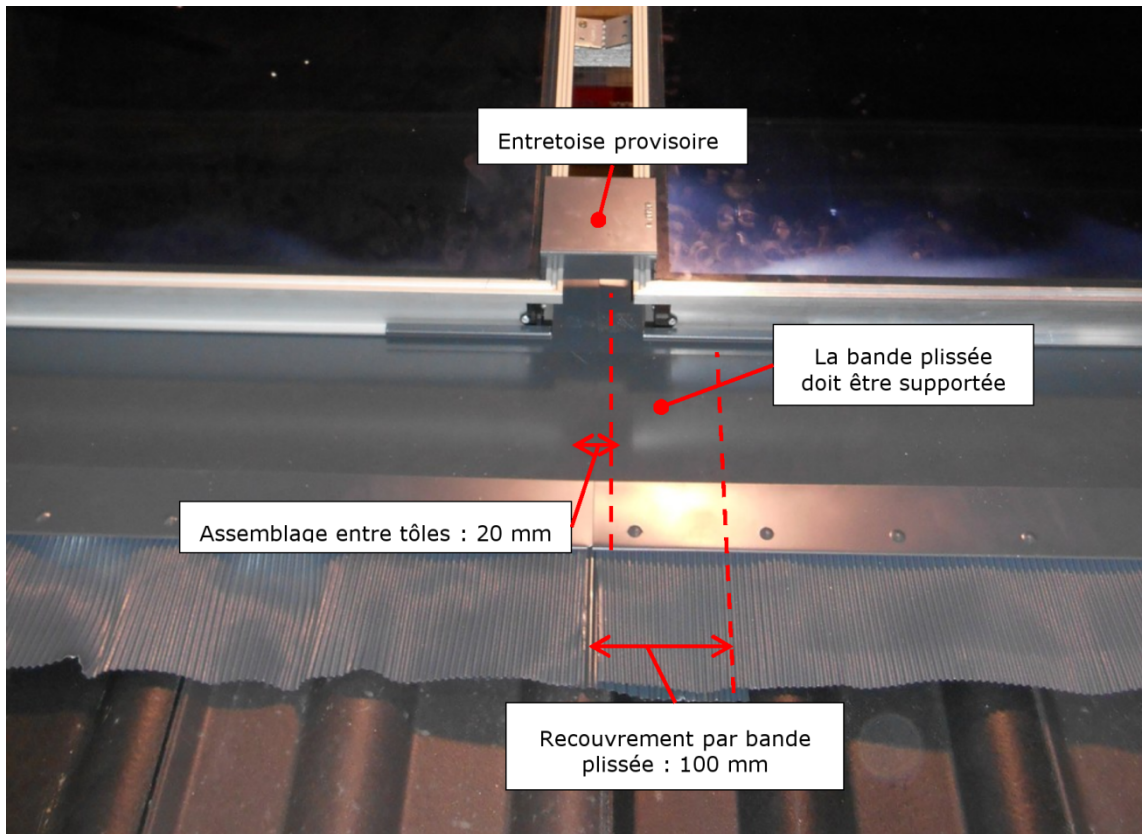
Bavette basse – raccordement latéral entre 2 bavettes
